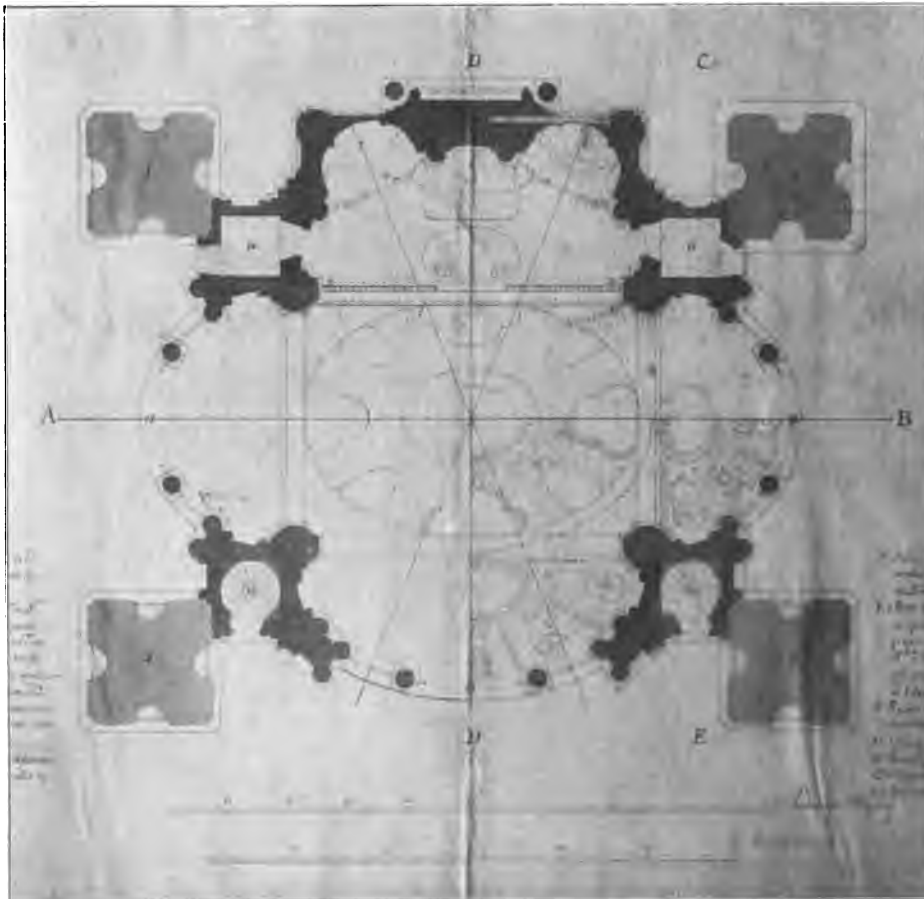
Kapelle der Nuestra Señora del Pilar in der gleichnamigen Kathedrale zu Zaragoza Grundriß (Nach dem Originalplan des Ventura Rodríguez)
